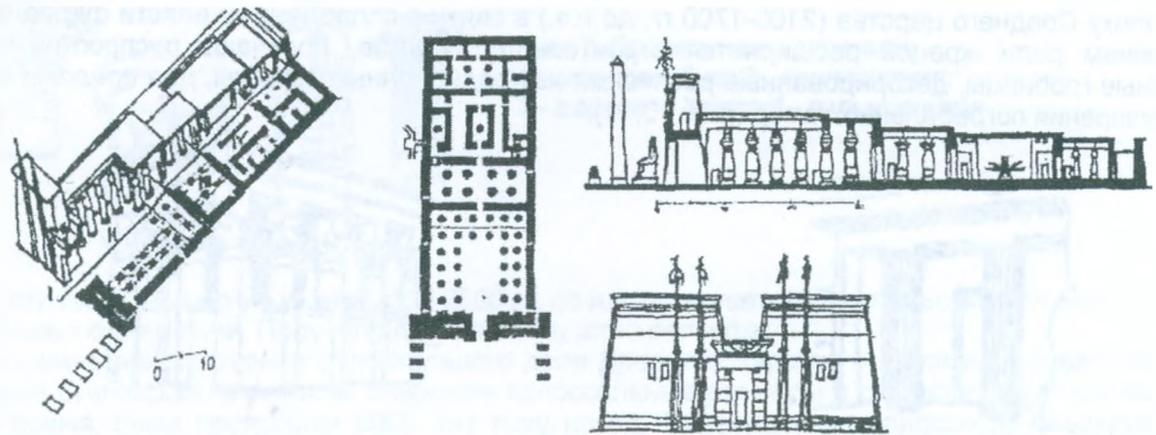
Храм Хонсу в Карнаке. Аксонометрия, план, продольный разрез, входной фасад с пилонами
